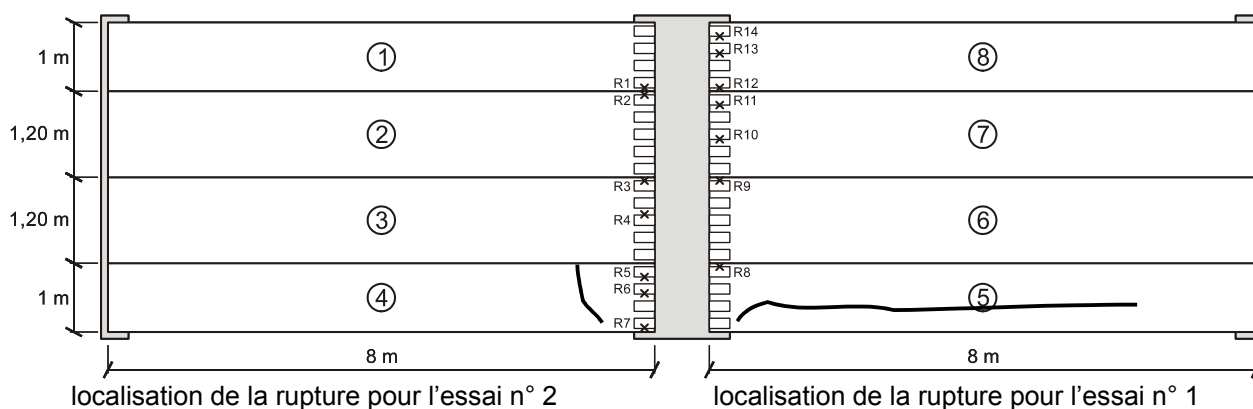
Localisation de la rupture du plancher à dalles alvéolées
